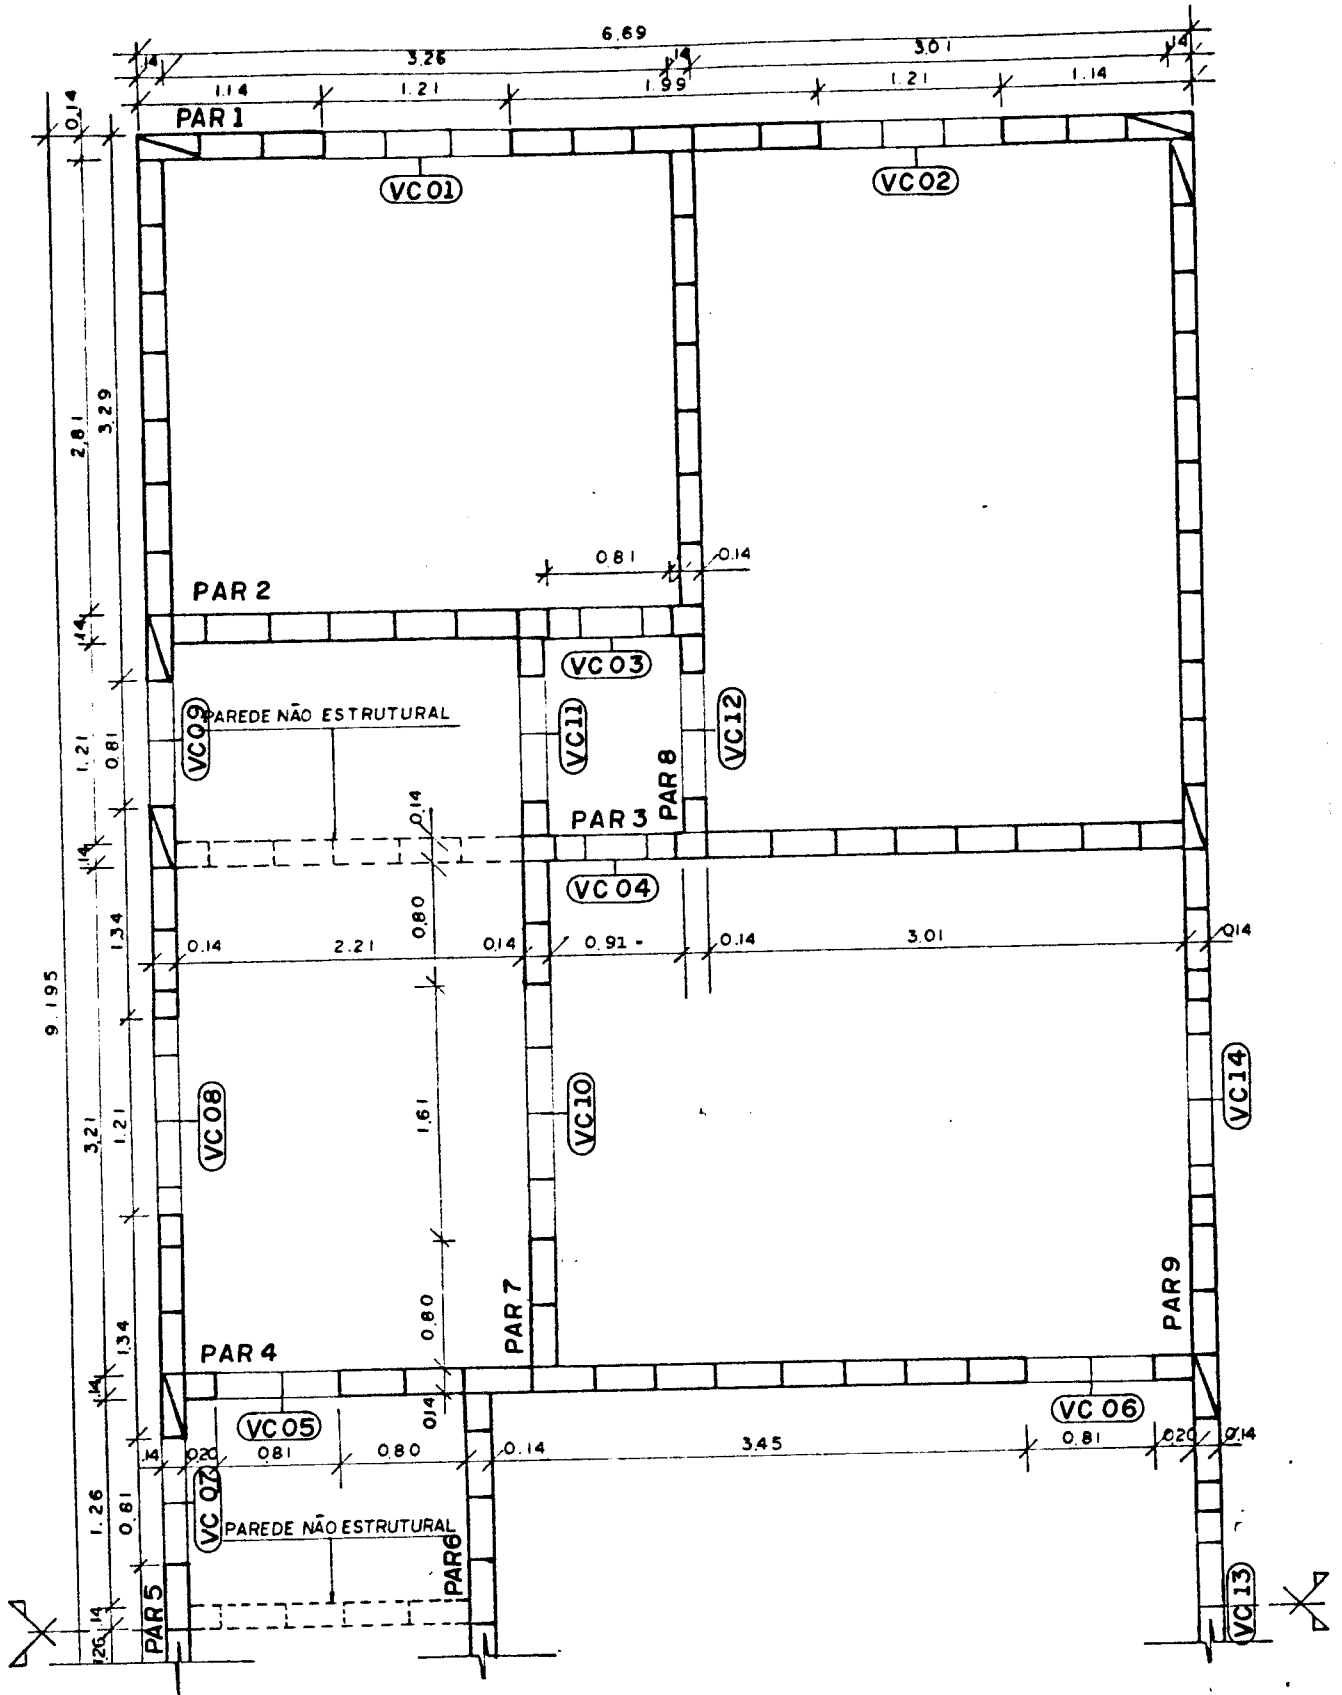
NOMENCLATURA DAS VERGAS E PAREDES DO ÚLTIMO PAVIMENTO.
